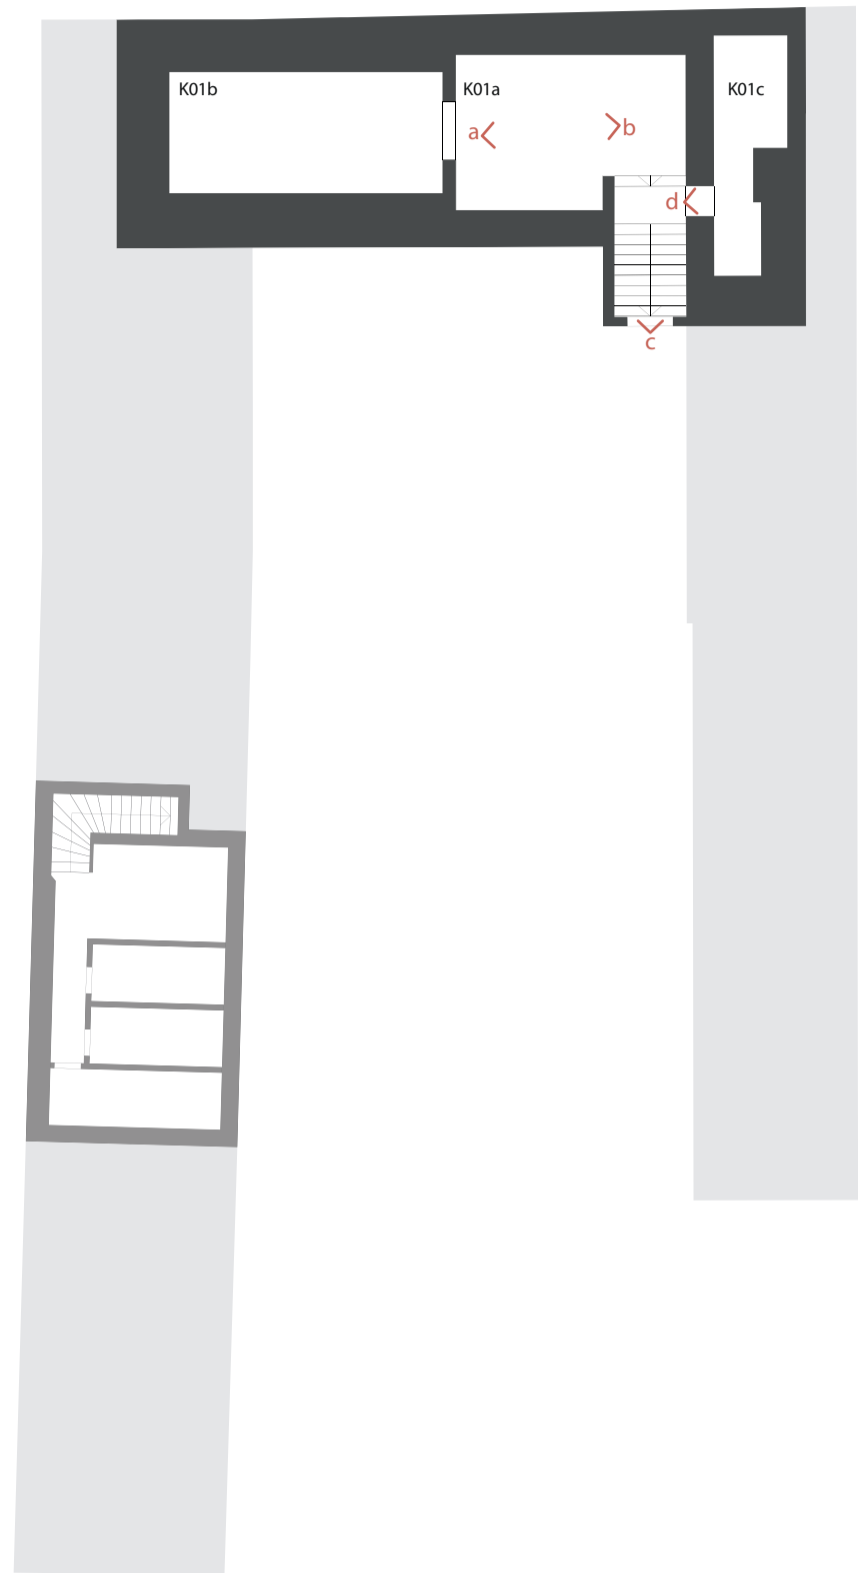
Grundriss Untergeschoß | M 1:200 | Keller 01
